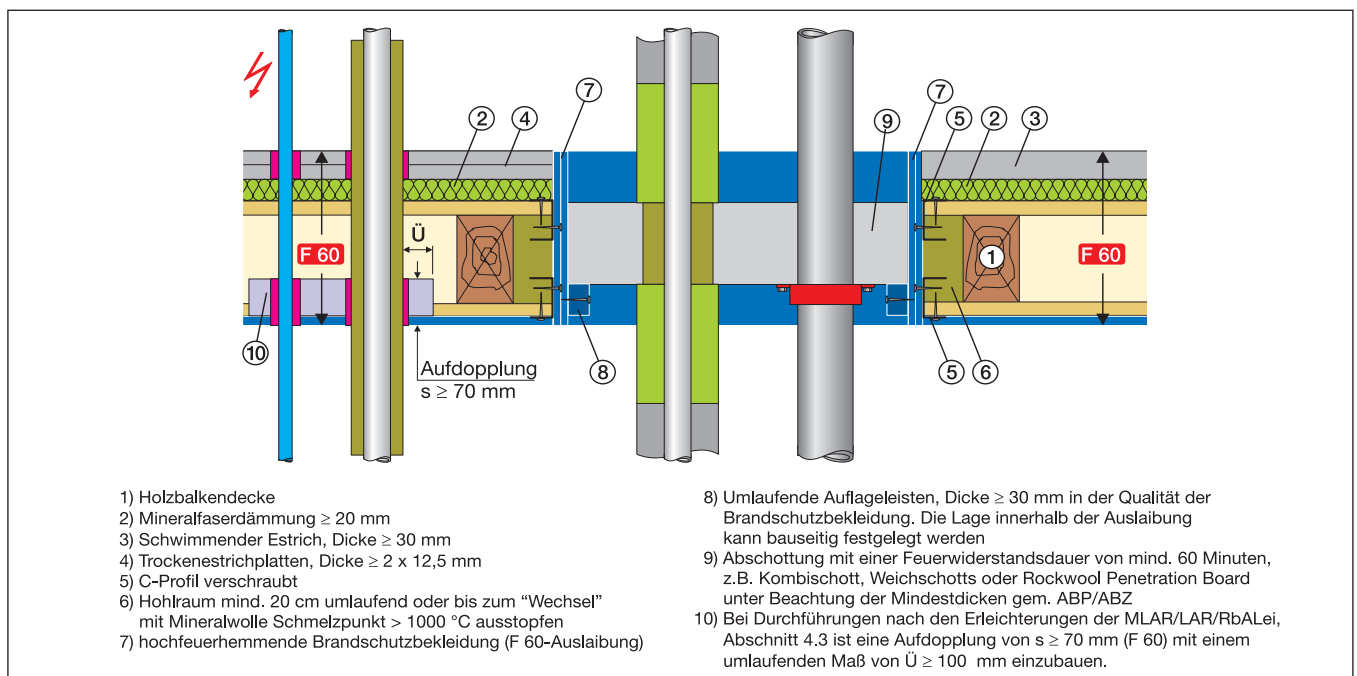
Prinzipskizze einer Leitungsabschottung/-durchführung durch eine hochfeuerhemmende Holzbalkendecke (Gesamtkonstruktion = F 60) in Anlehnung an die Holzbau-Richtlinie. Das Abschottungsprinzip kann auf Holzbalkendecken F 30 übertragen werden.
